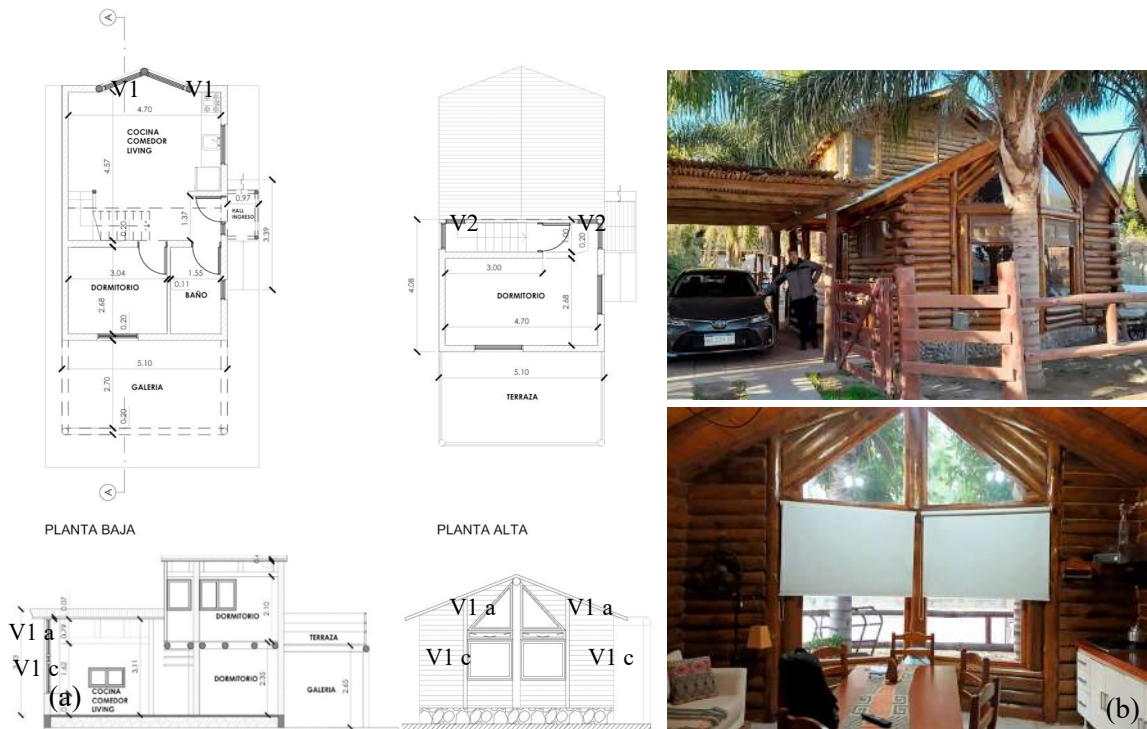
Planos (planta baja y alta), fachada y corte de CCB (a). Imágenes del exterior e interior de la cabaña (b). Fuente: E.P.
